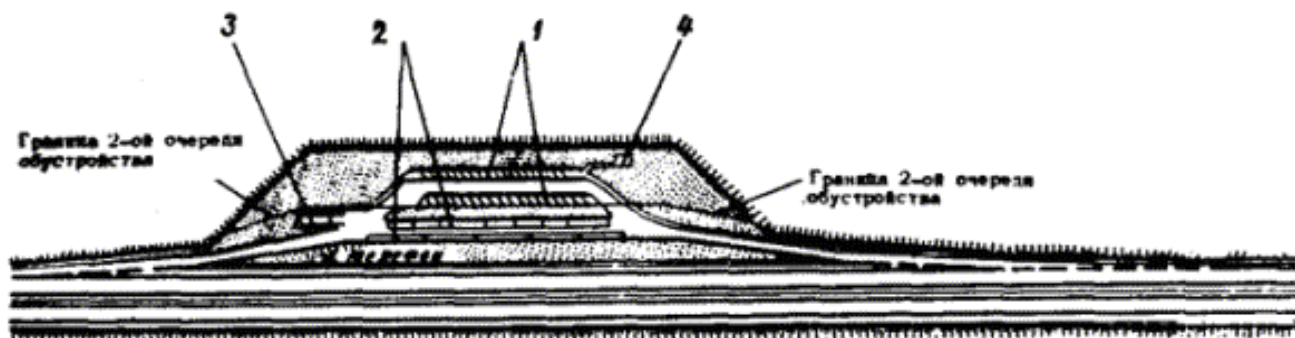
Схема площадки для стоянки на перегоне (французский вариант)
